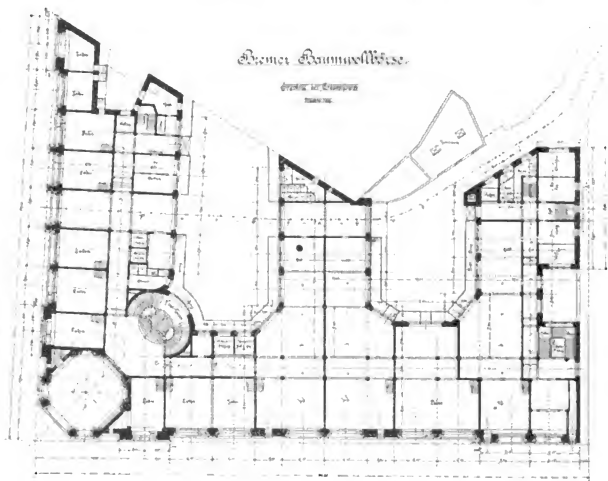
Grundriß des Erdgeschosses der Baumwollbörse. J. Poppe. 1899.
